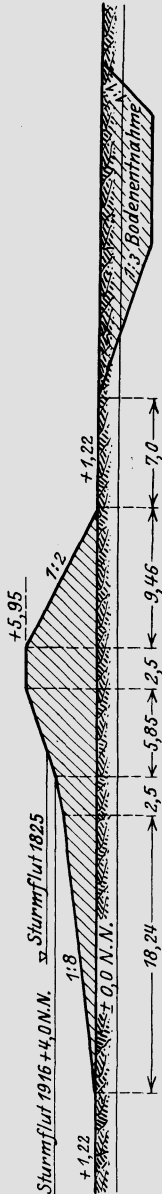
Deichquerschnitt nach Hinriehs, Maßstab 1:500.
